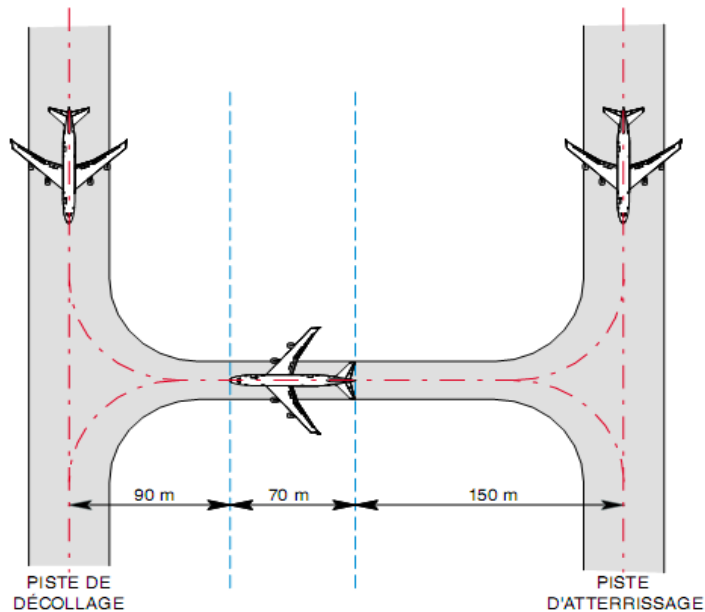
Calcul de la distance minimale entre 2 pistes parallèles avec un avion de longueur 70 mètres
